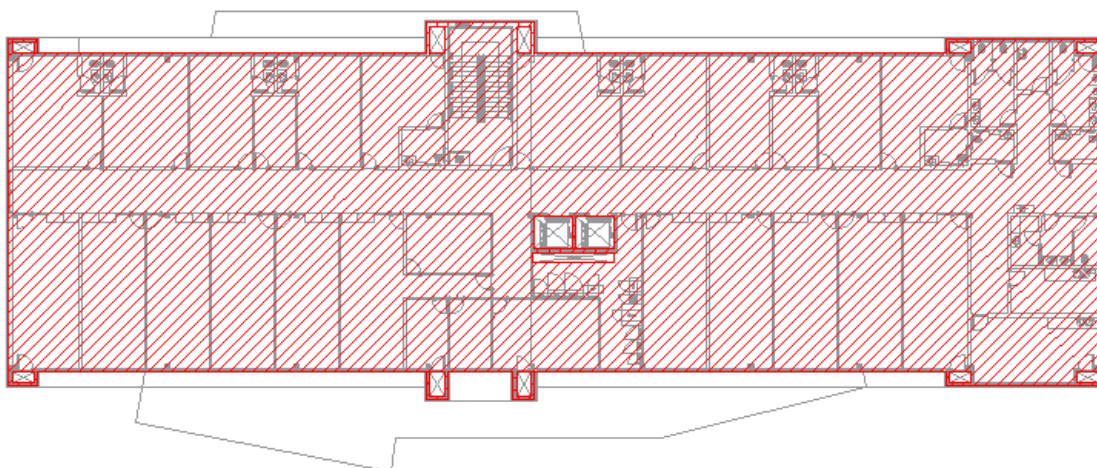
Área considerada para pavimento tipo (1º Pavimento)
